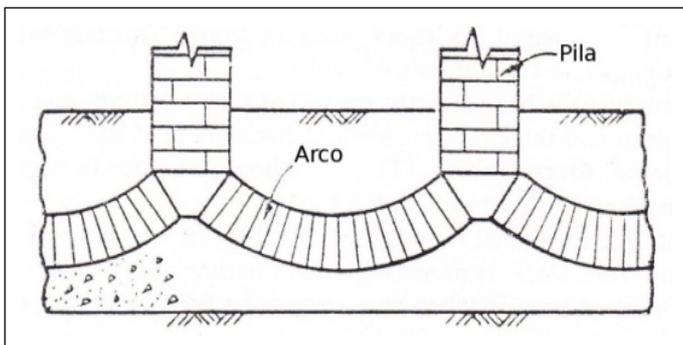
Primeras estructuras laminares de cimentación. [2]
